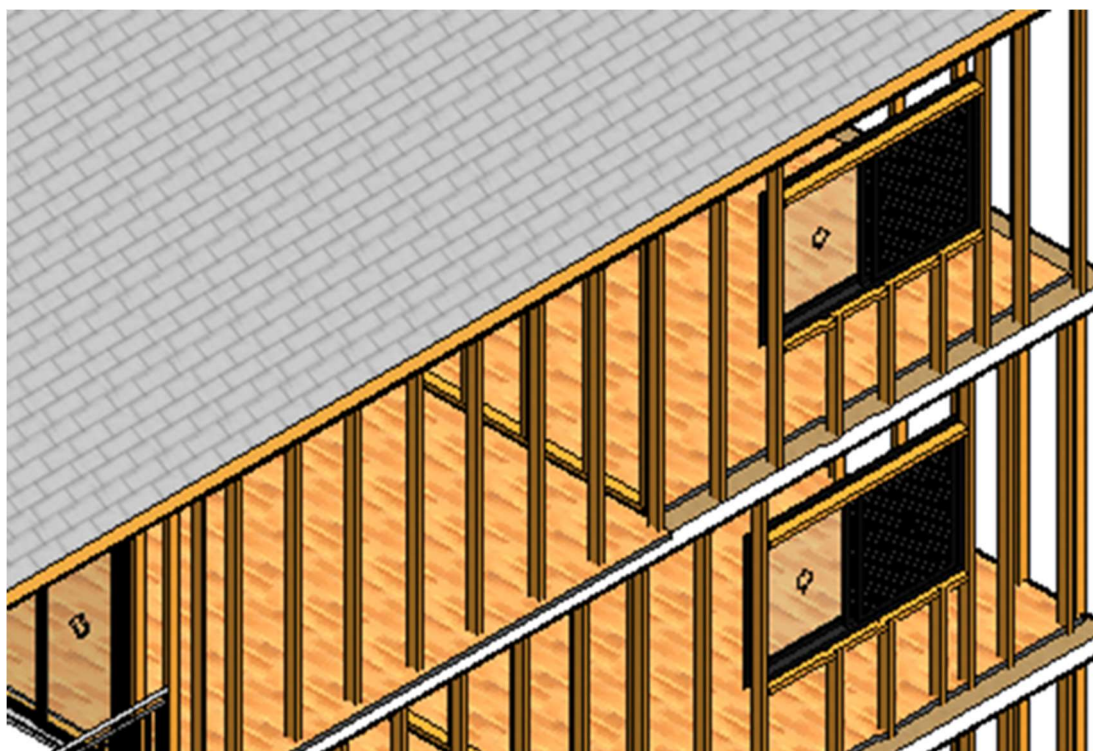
Detalhamento da parede em *wood frame* com o Revit Extension
